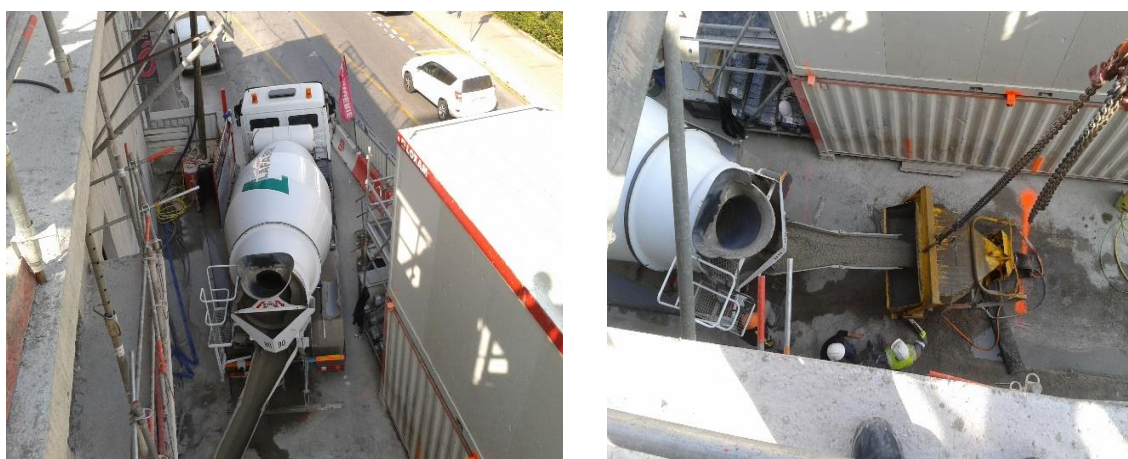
Receção do betão e transporte através do balde para betão até ao elemento a betonar
